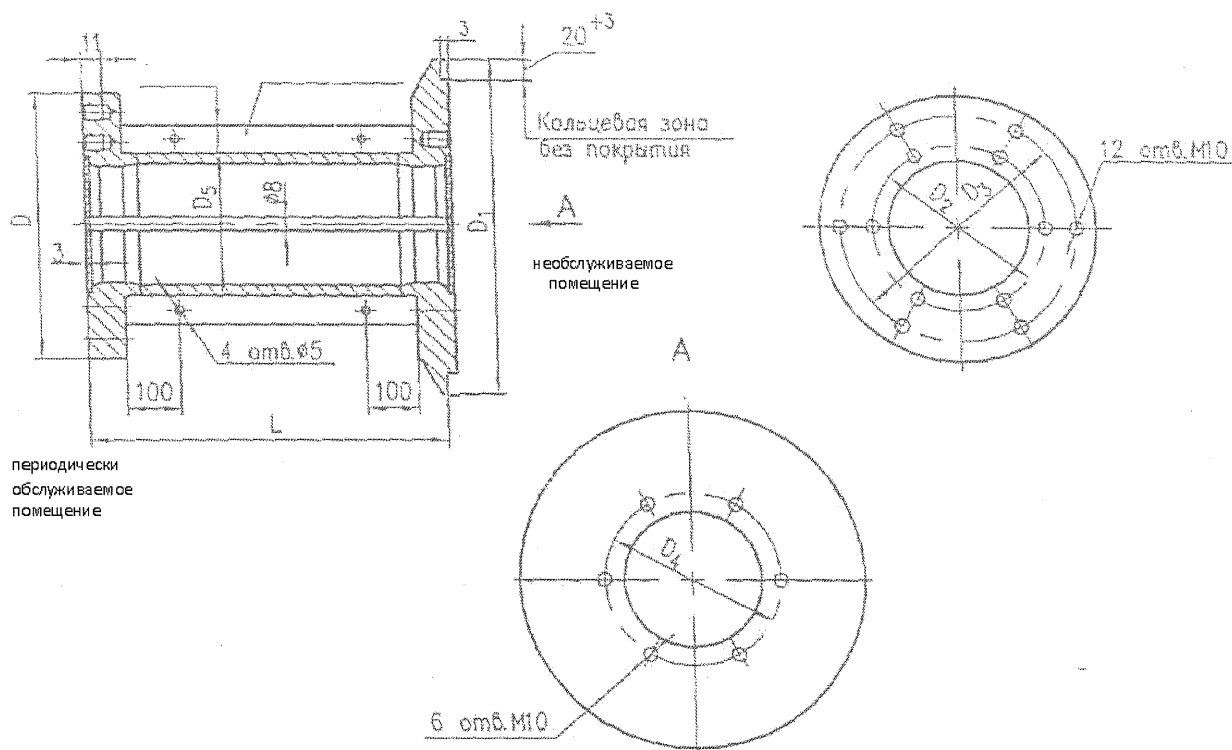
Габаритный чертеж закладной под штоковую проходку
